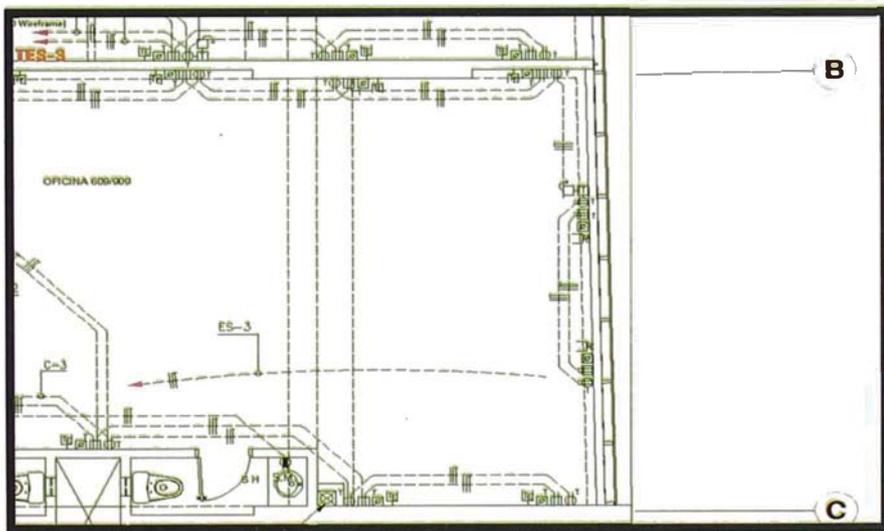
Planta de tomacorrientes- Inst. Eléctricas, lámina IE-22.
